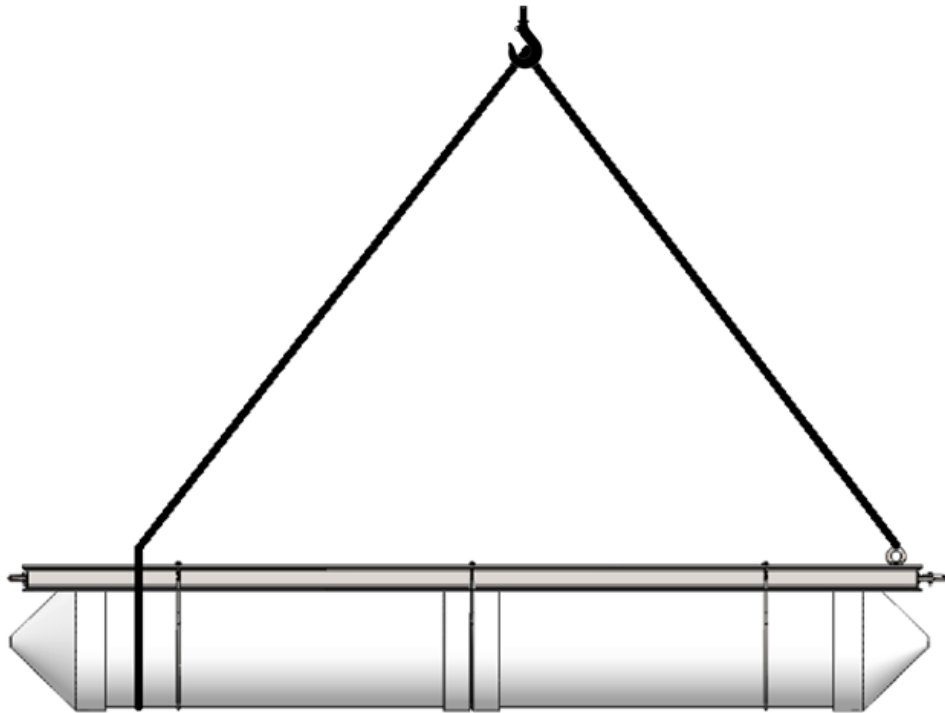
Vista lateral de elevación de sistema emplazamiento. Elaborado por los autores.
